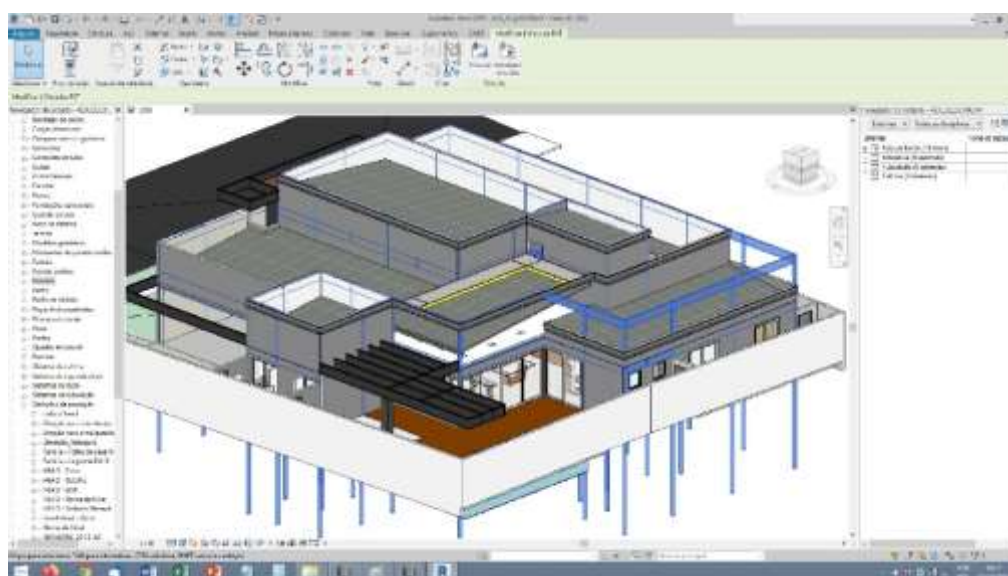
Compatibilização dos elementos metálicos e de concreto armado
